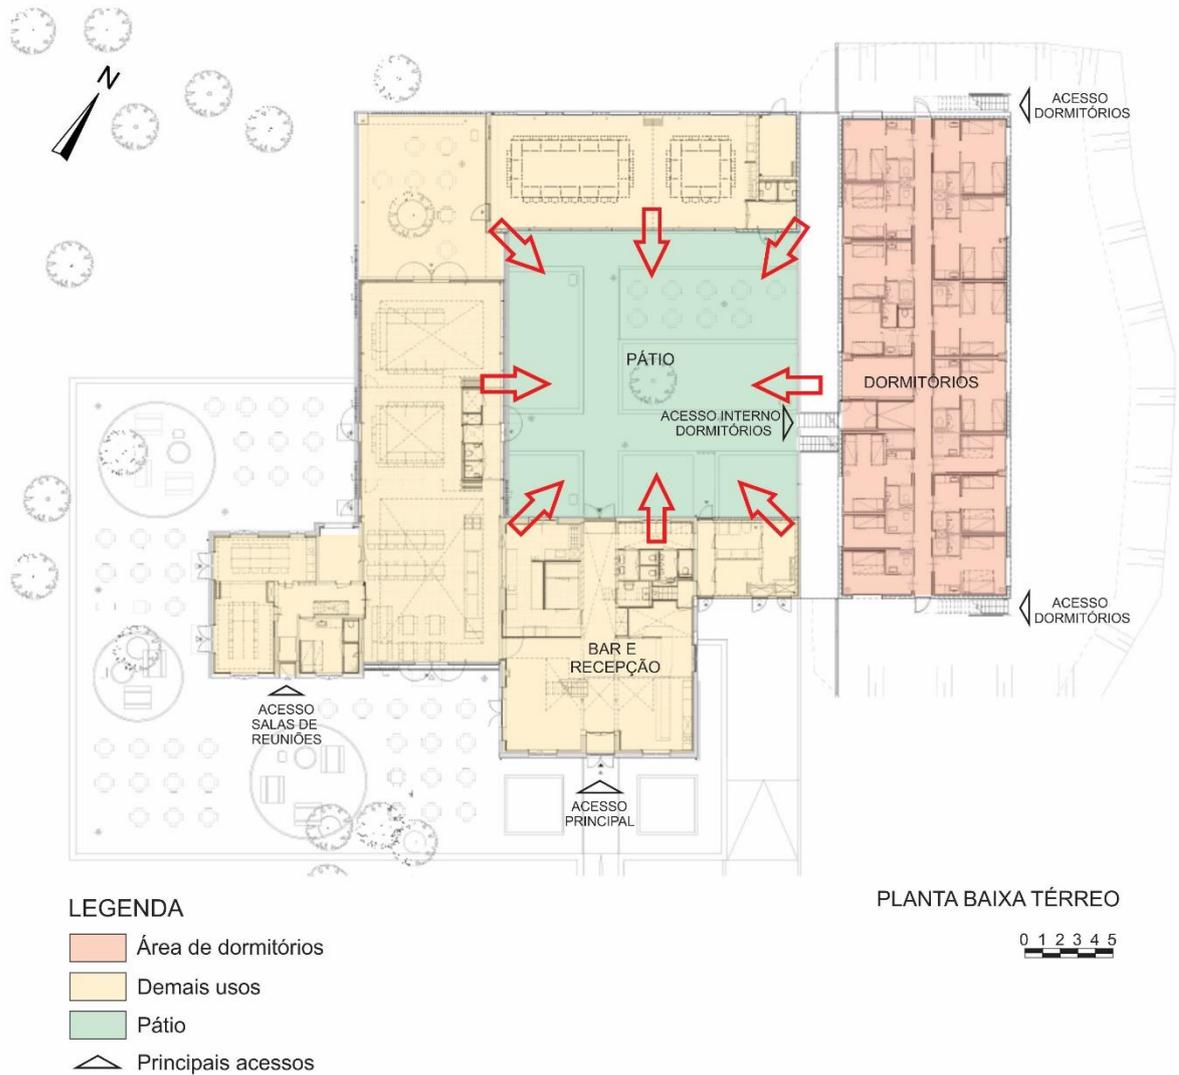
Planta baixa térrea do Stayokay Hostel Soest. FONTE: ARCHDAILY (2012, adaptada pela autora).
